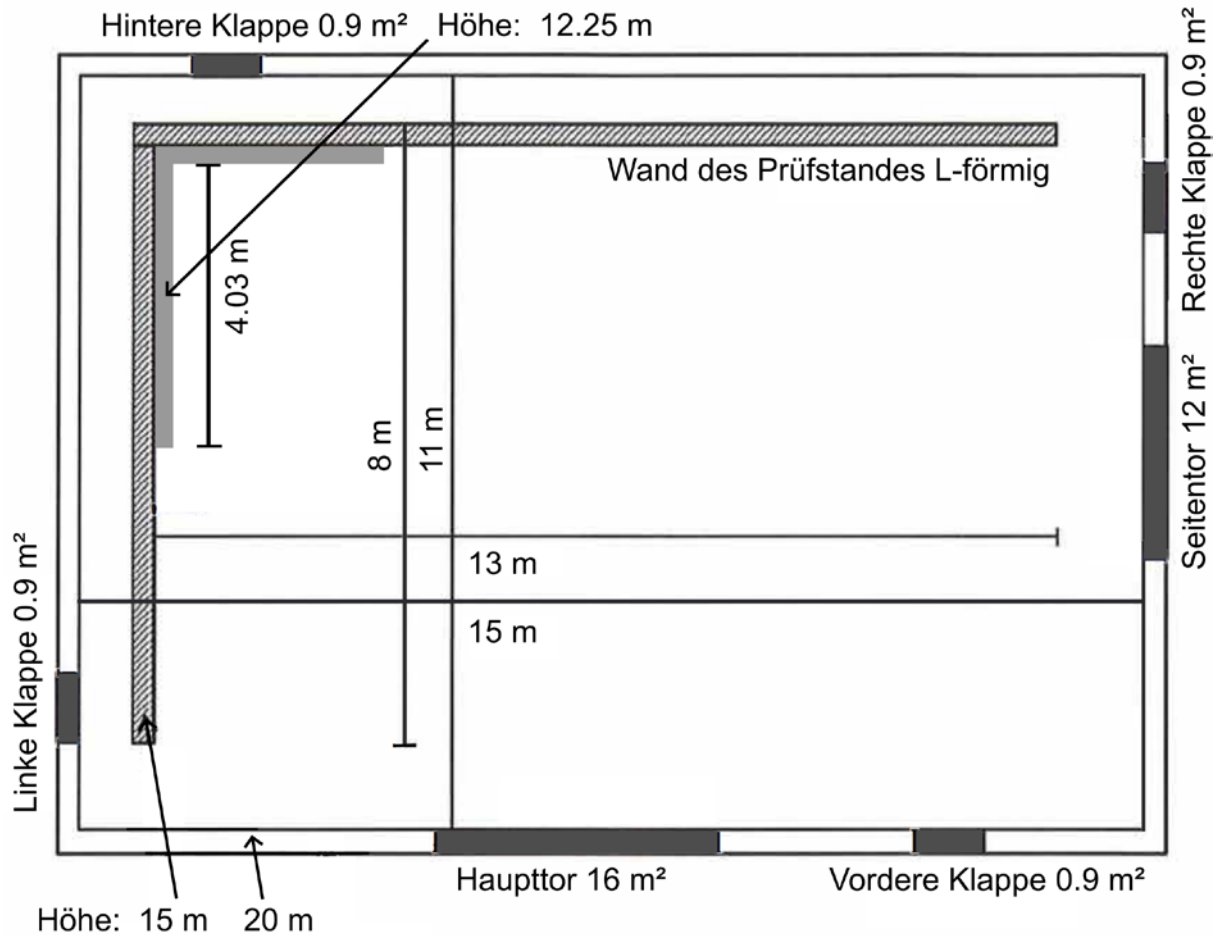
Grundriss der Prüfhalle mit Prüfstand der Kiwa MPA Dresden GmbH
